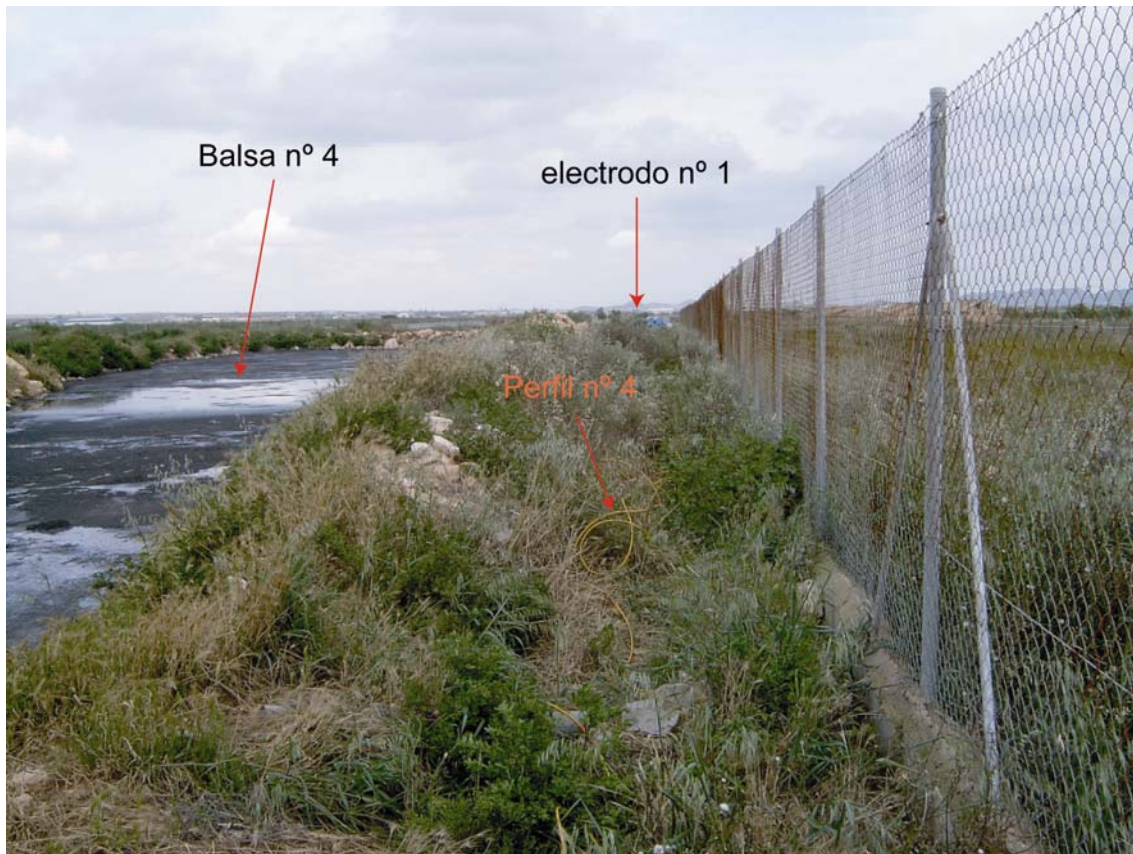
39. Vista parcial del perfil n° 4 exteriormente a la balsa n° 4.
